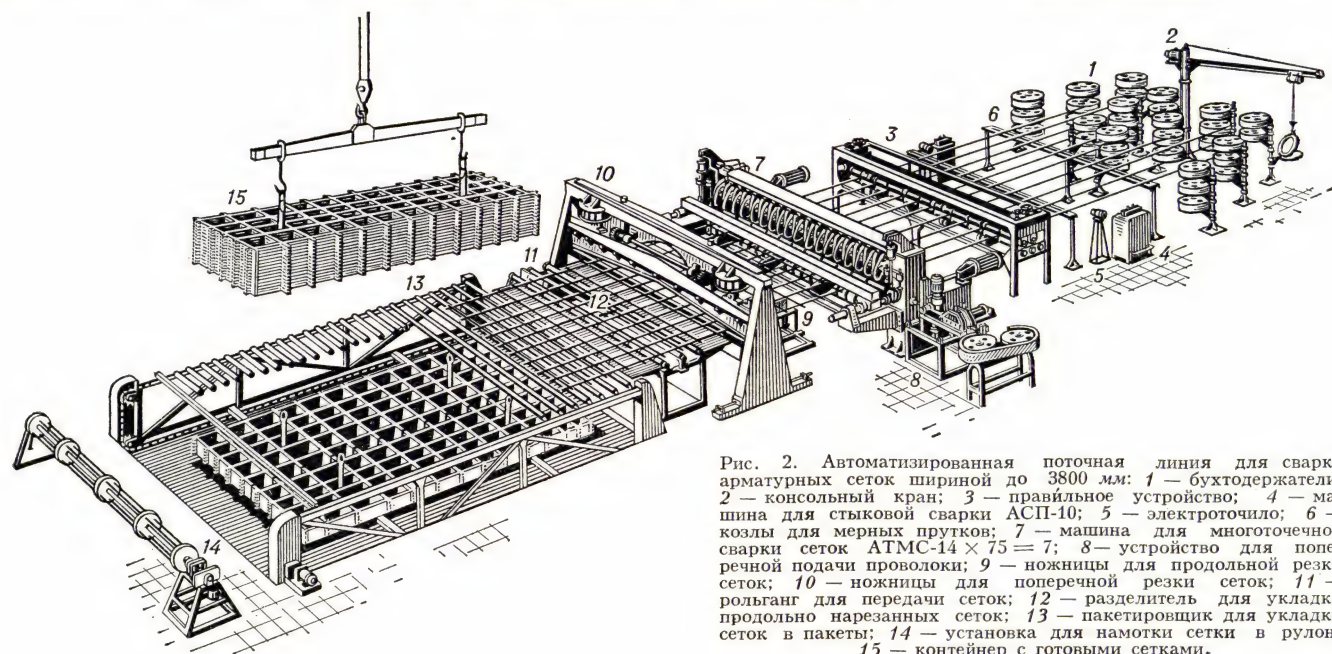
Автоматизированная поточная линия для сварки арматурных сеток шириной до 3800 мм: 1 — бухтодержатель; 2 — консольный кран; 3 — правильное устройство; 4 — машина для стыковой сварки АСП-10; 5 — электроточило; 6 — козлы для мерных прутков; 7 — машина для многоточечной сварки сеток АТМС-14×75; 8 — устройство для поперечной подачи проволоки; 9 — ножницы для продольной резки сеток; 10 — ножницы для поперечной резки сеток; 11 — ролик для передачи сеток; 12 — разделитель для укладки продольно нарезанных сеток; 13 — пакетировщик для укладки сеток в пакеты; 14 — установка для намотки сетки в рулон; 15 — контейнер с готовыми сетками.
